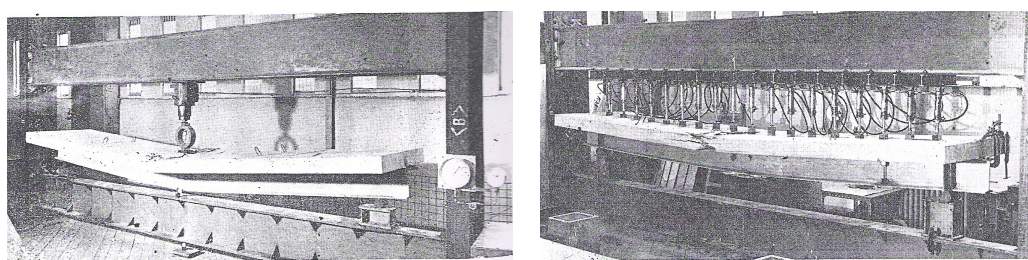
Ensaios experimentais com aplicação de cargas concentradas e distribuídas [6]
